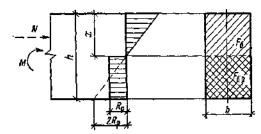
Схема усилий и этнора напряжений в сечении, нермальном к продольной оси нзгибаемого (внецентренно-сжатого) бетоиного элемента, рассчитываемого с учетом сопротивления бетона растянутой зоны
